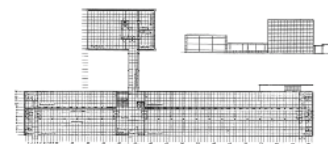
Prefeitura de Rodovre, Dinamarca, 1954-1956. Arquiteto: Arne Jacobsen. Planta Baixa.
